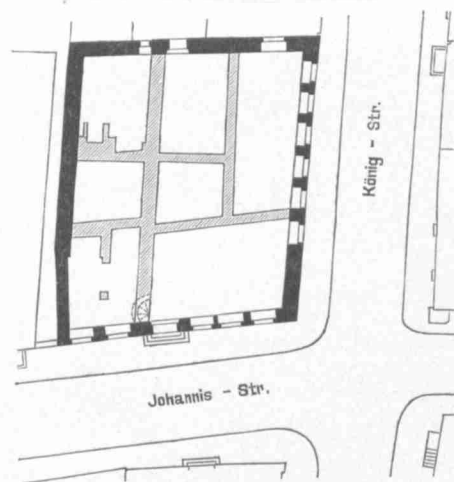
Alter Grundriss mit eingezeichneten Kellermauern.
